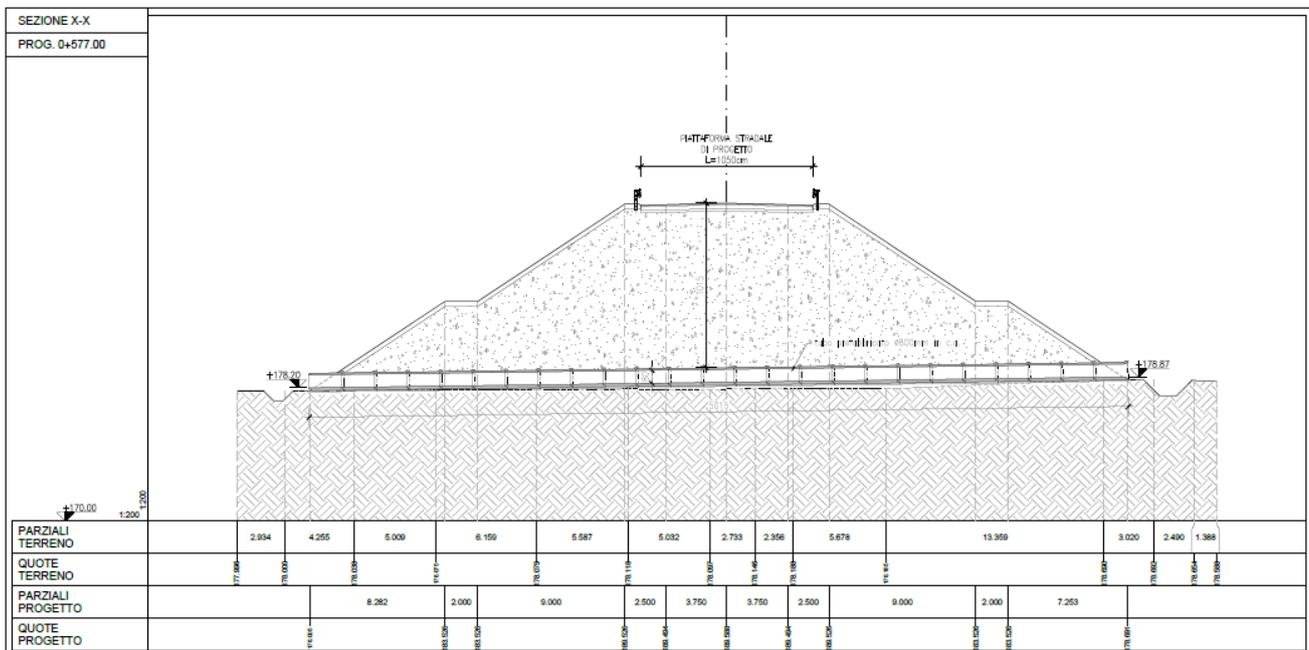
Sezione del rilevato in corrispondenza della tubazione.
